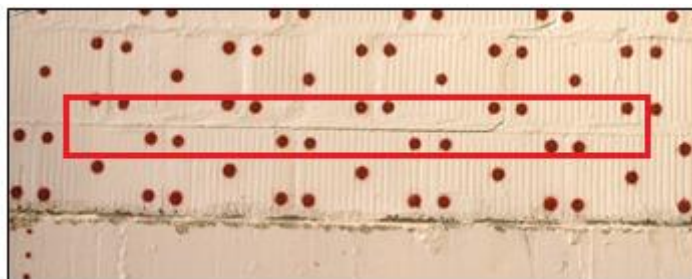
Fissura ao longo da primeira junta horizontal da parede de alvenaria.
